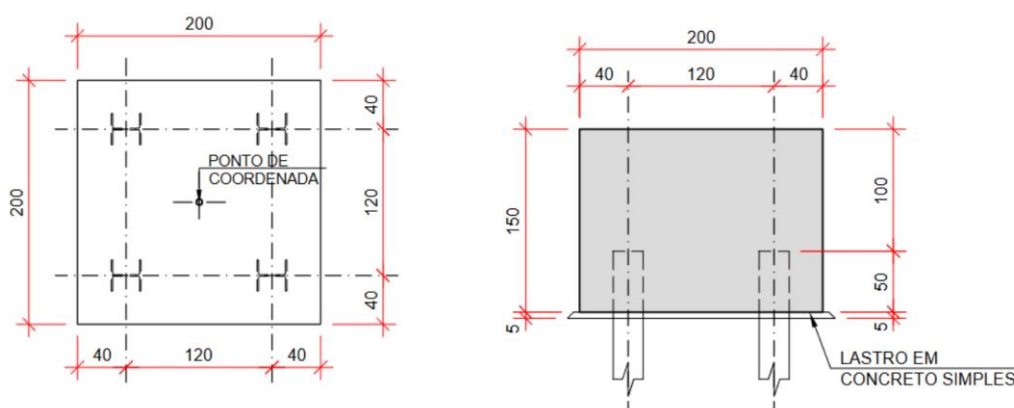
DETALHES DO BLOCO DE FUNDAÇÃO (EIXOS E2 A E9, E E13 A E17)
